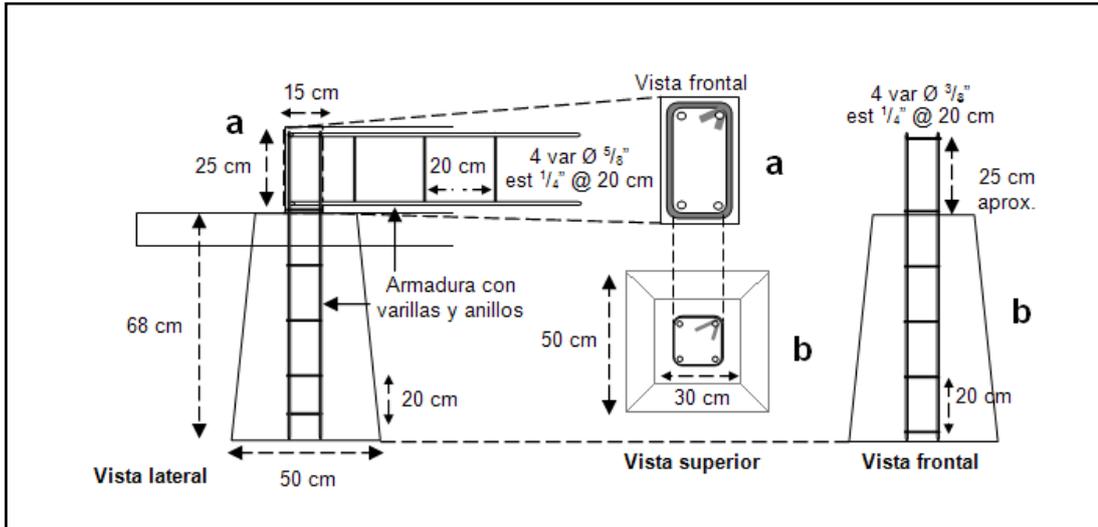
Características de las armaduras, horizontal y vertical (diámetros, N° de varillas y estribos): a) Cadena de cimentación (horizontal); b) Zapatas aisladas (vertical).
